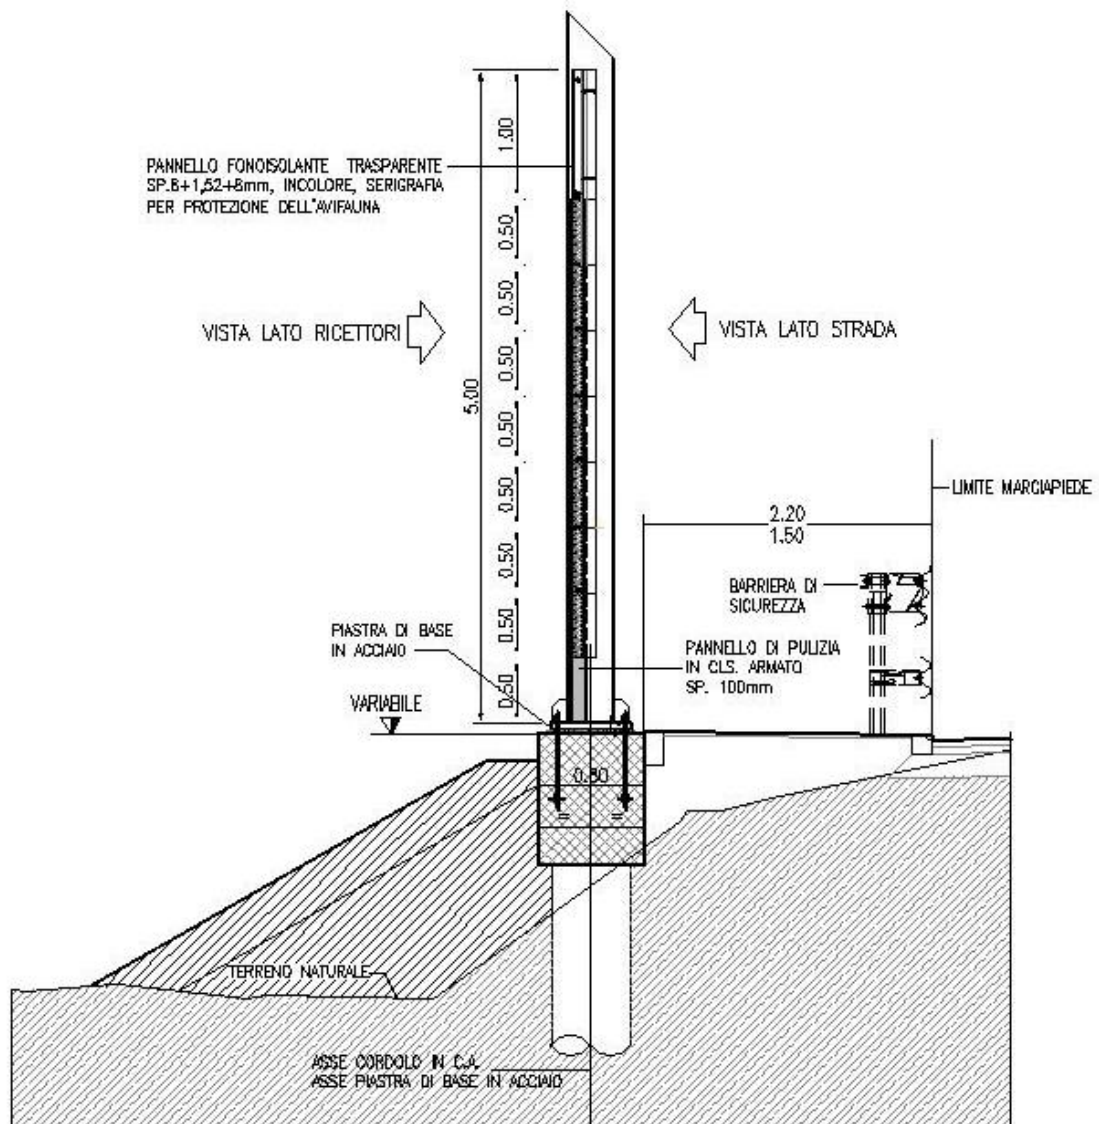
Dettagli architettonici delle barriere acustiche in rapporto alla condizione di installazione (in corrispondenza rilevato)
